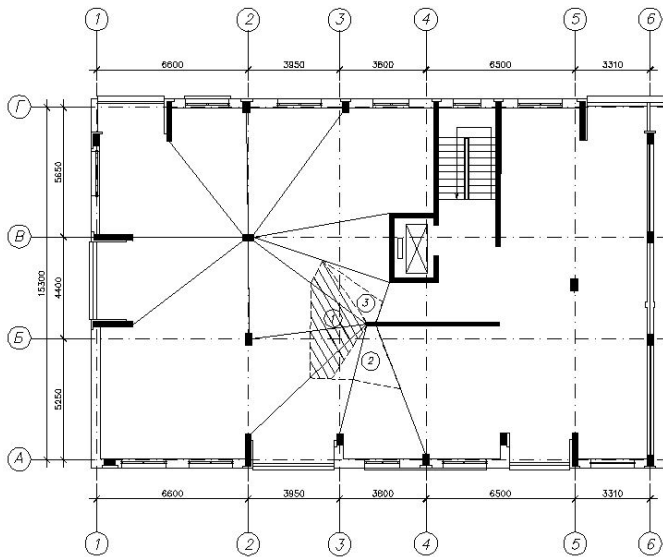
Фрагмент плана 3-го этажа административно-хозяйственного здания
